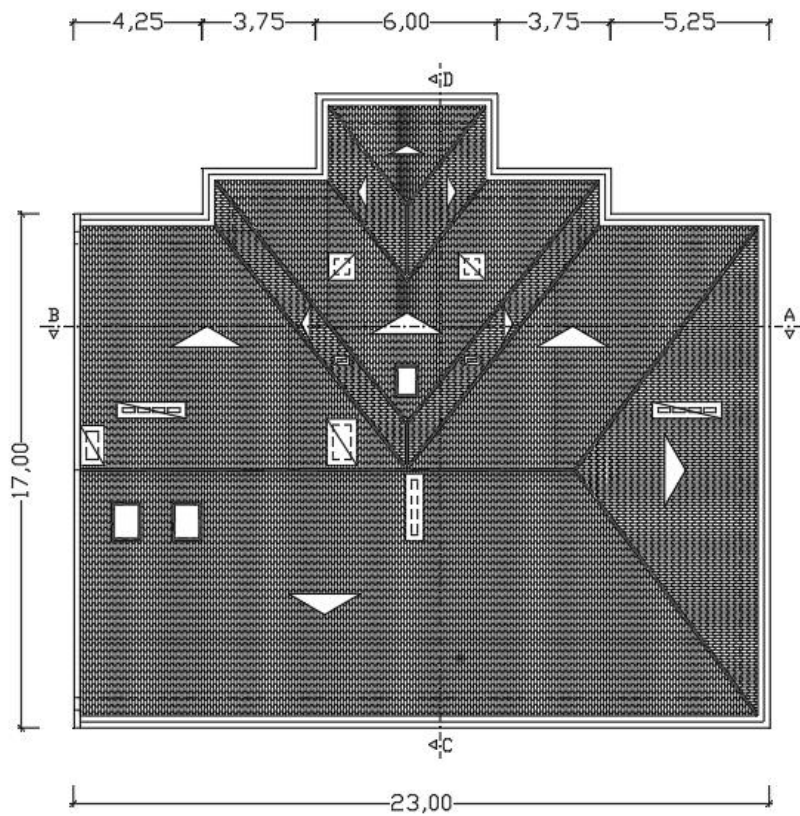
Planta arquitetónica da cobertura (AutoCad).
